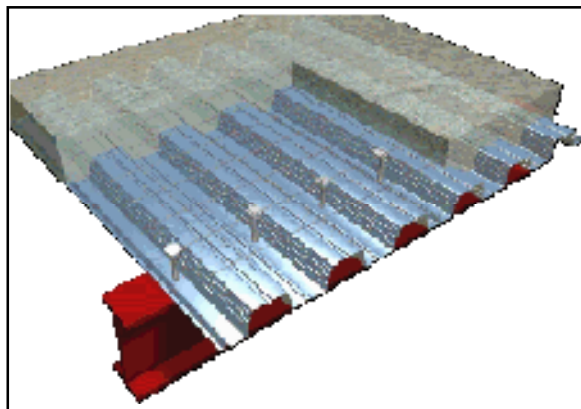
Laje com fôrma de aço incorporada apoiada sobre uma viga mista [15]
